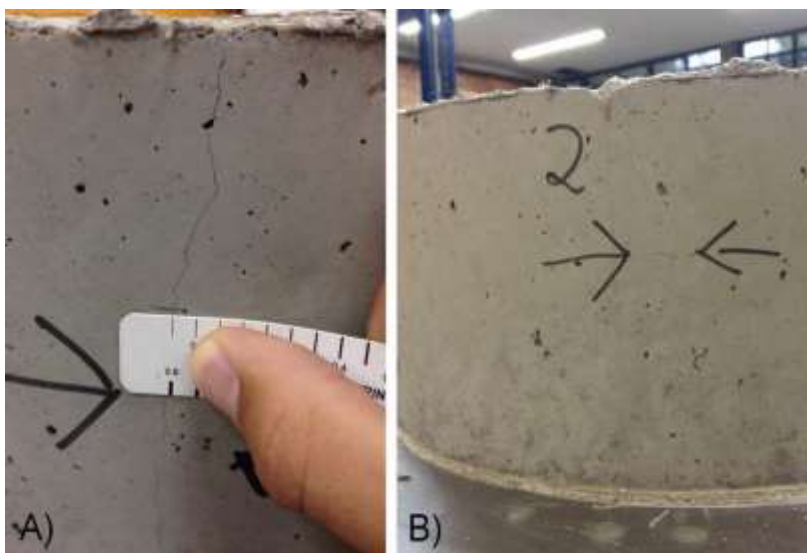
Fissuração da amostra CFN 02 do concreto reforçado com fibra de poliéster nova
